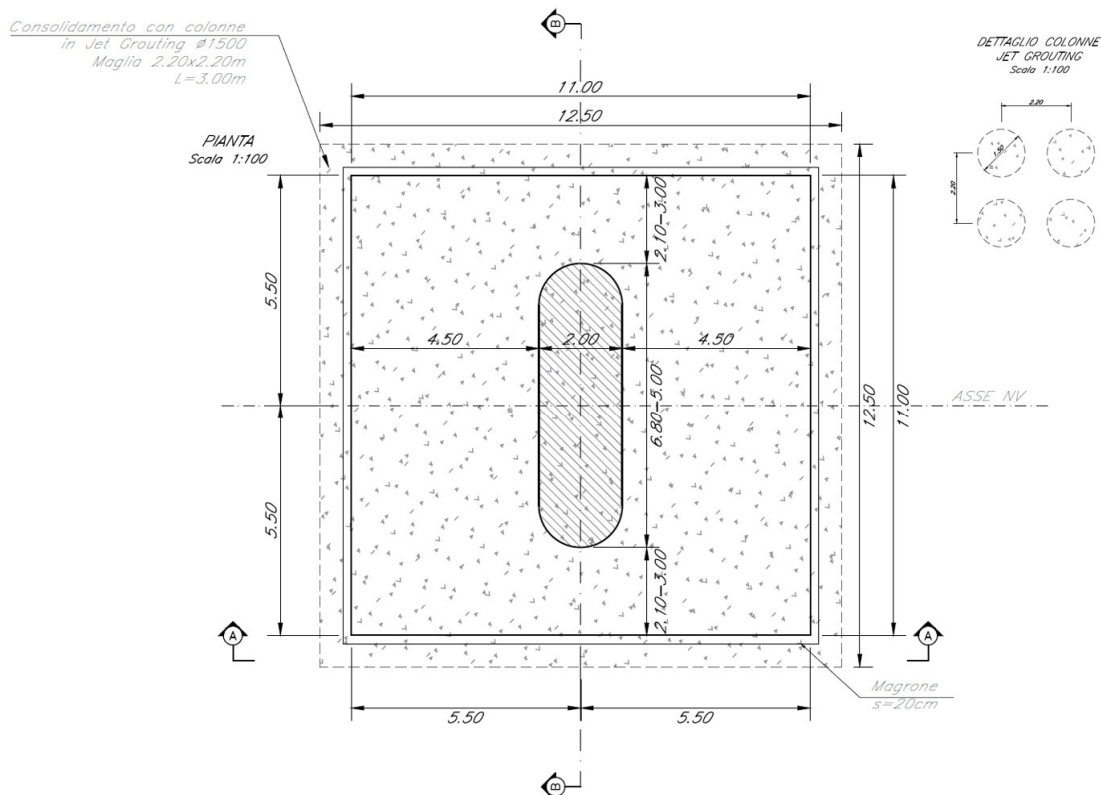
Pianta fondazione diretta su colonne in jet grouting D1500 interasse $i=2.20$ m
